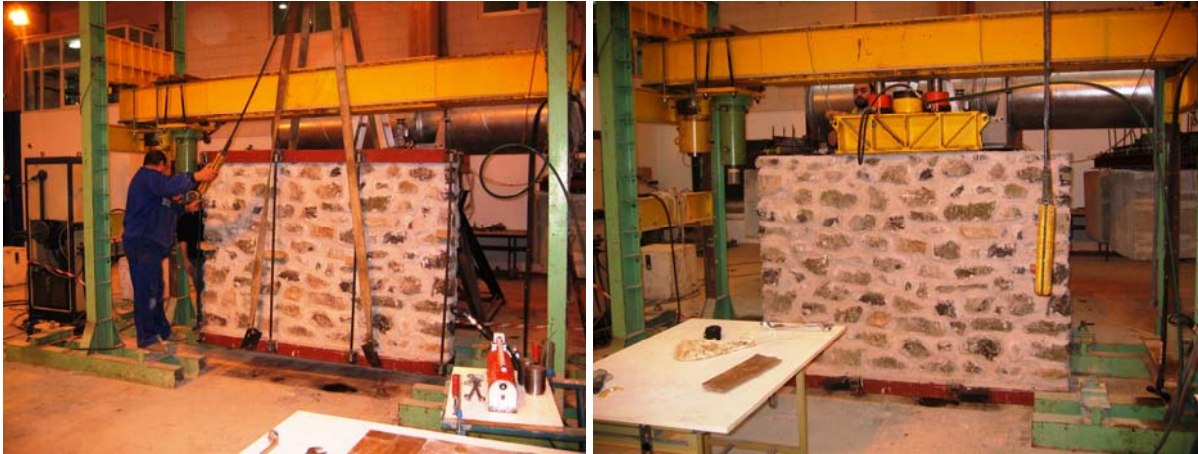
Instante tomado durante el transporte del muro de mampostería bajo el pórtico de carga.
